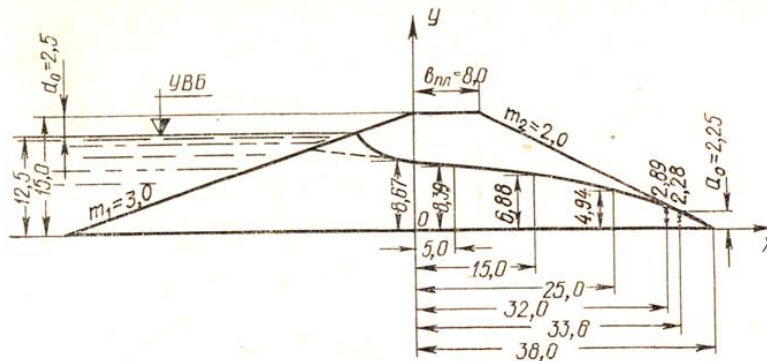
Расчетная схема фильтрации через однородную земляную плотину на водонепроницаемом основании, без дренажа и при отсутствии воды в нижнем бьефе
